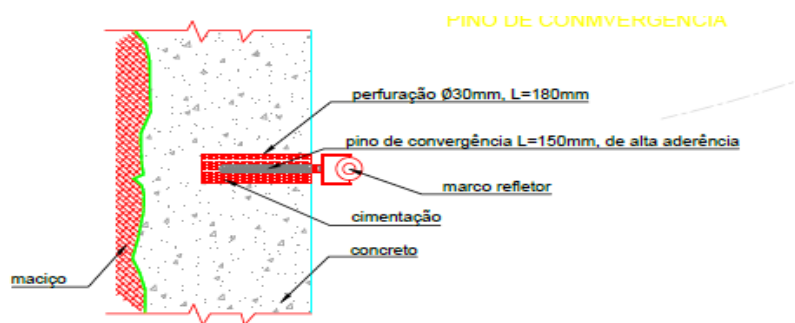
Pormenor - instalação de alvos. (adaptado Plano Instrumentação TAS)
